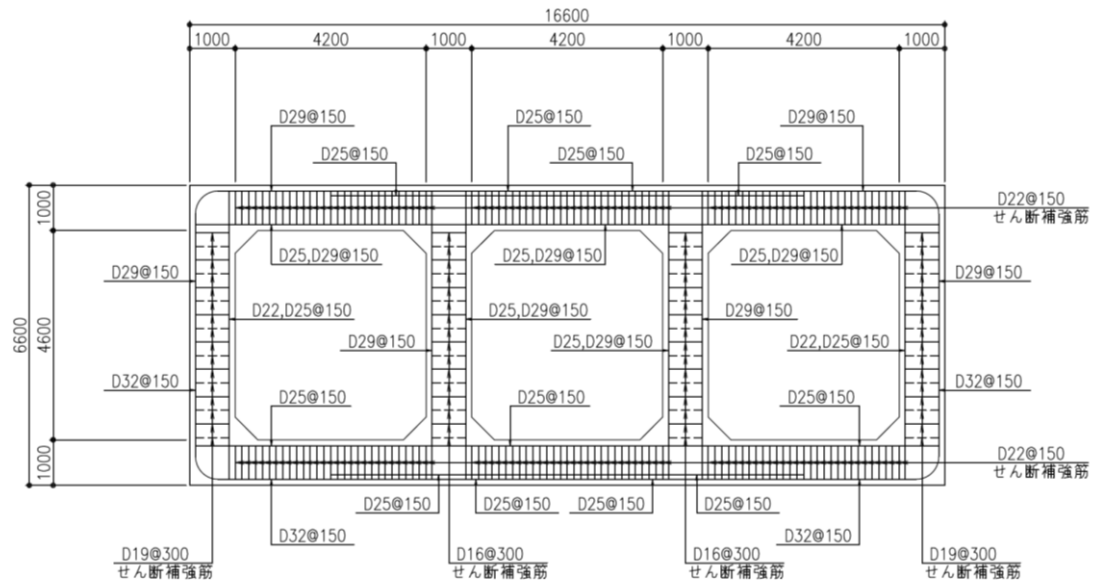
(3) 取水路の断面図 (漸拡部 C-C 断面)
